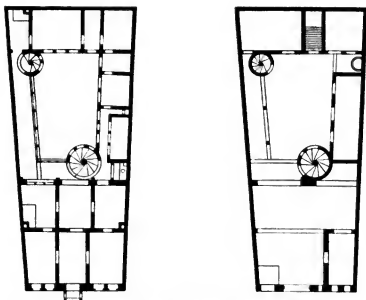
Grundrisse des Funkschen Hauses in Nürnberg.
